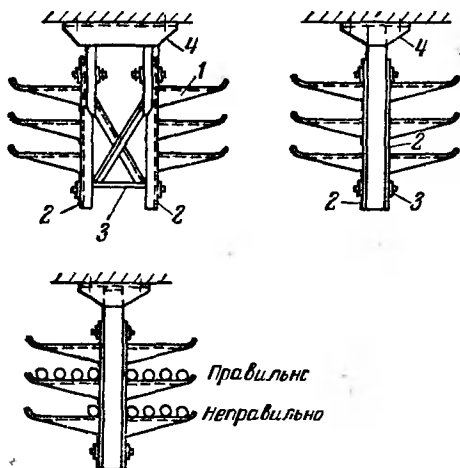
Конструкции для прокладки кабелей под перекрытиями.
